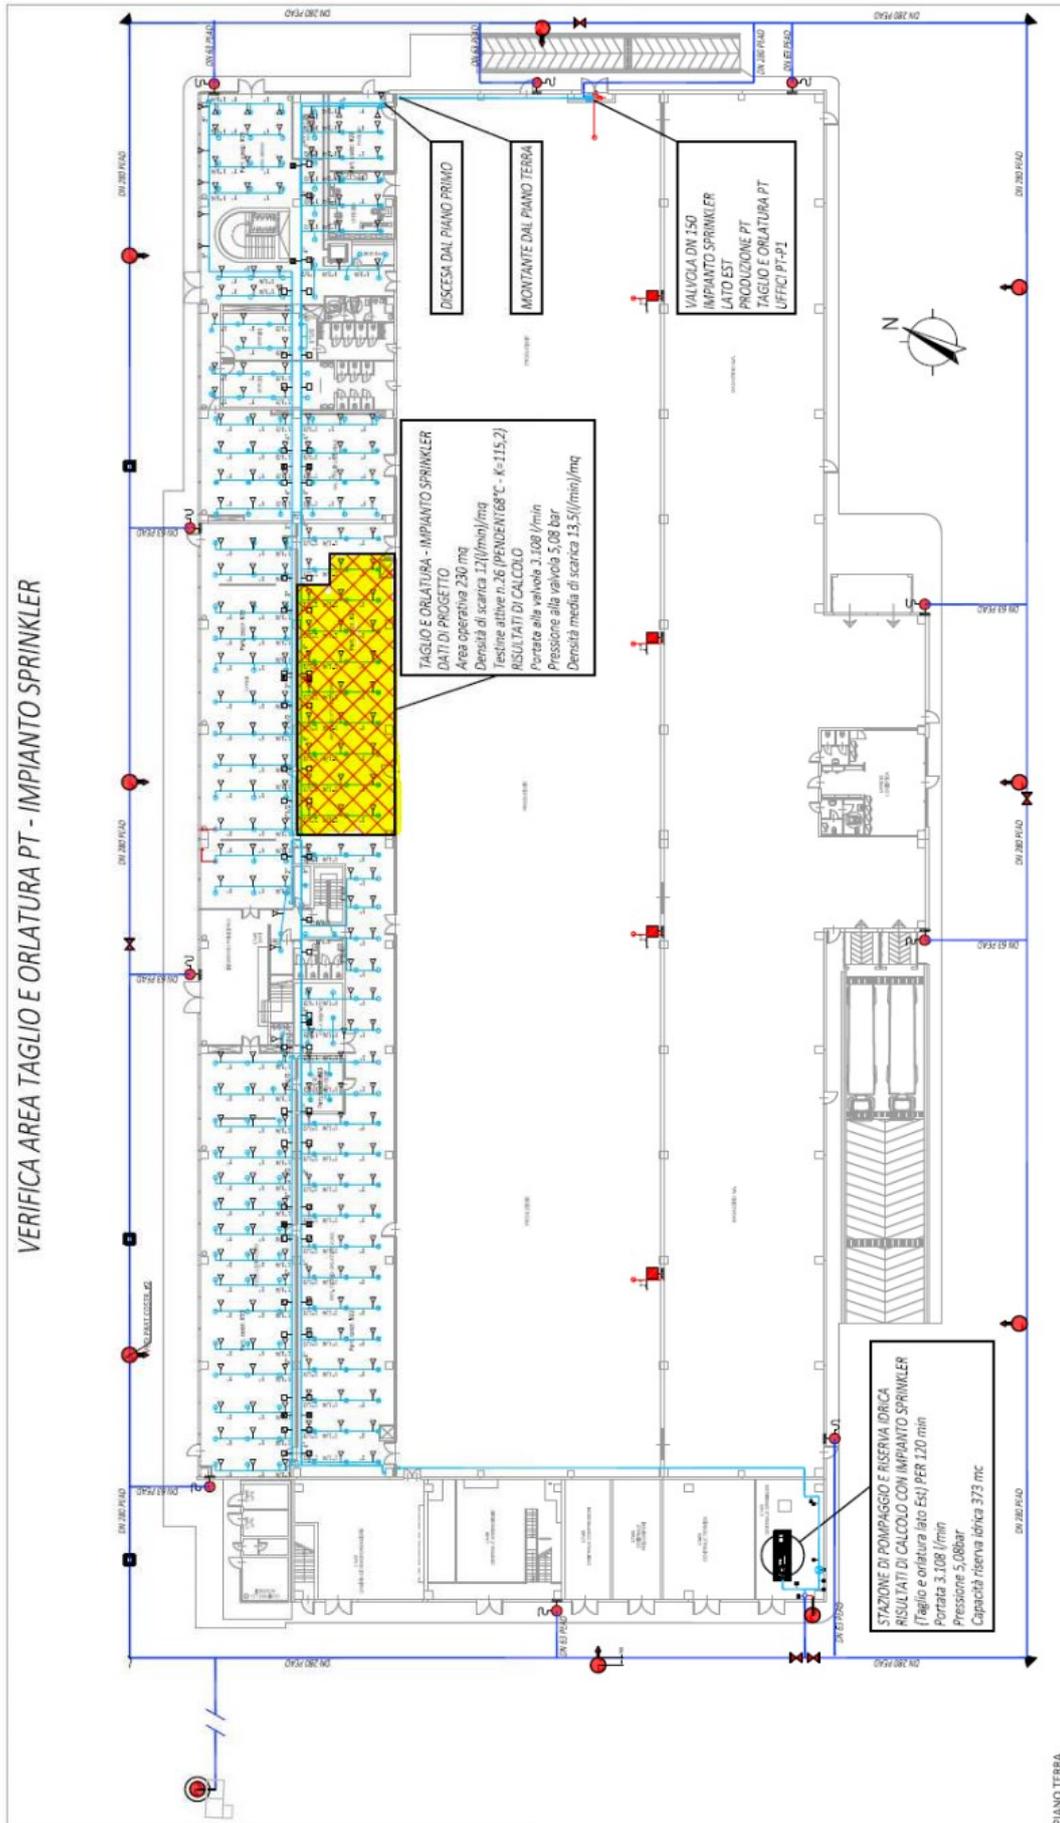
Planimetria area oggetto di verifica calcolo 4
